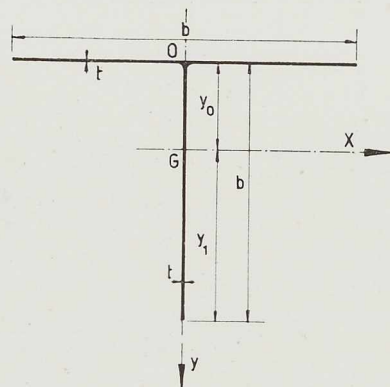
Profil T obtenu par soudage de tôles minces.
